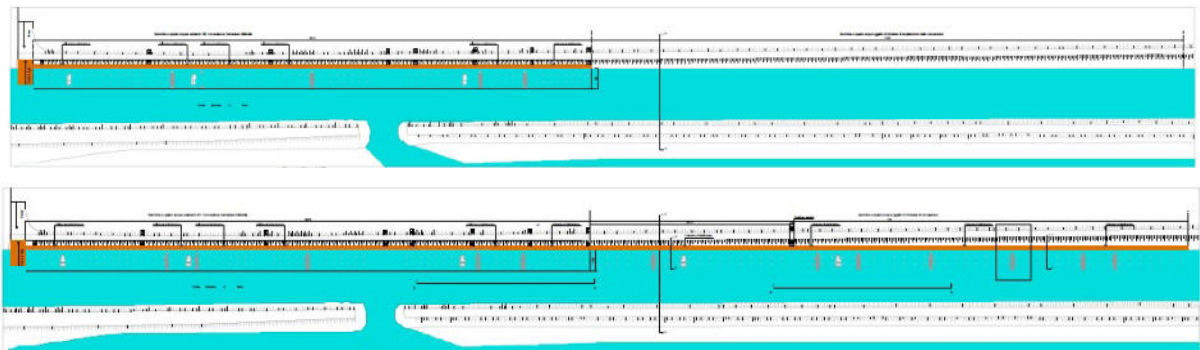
Planimetria dell'area nello stato di fatto (in alto) e nello stato di progetto (in basso).
